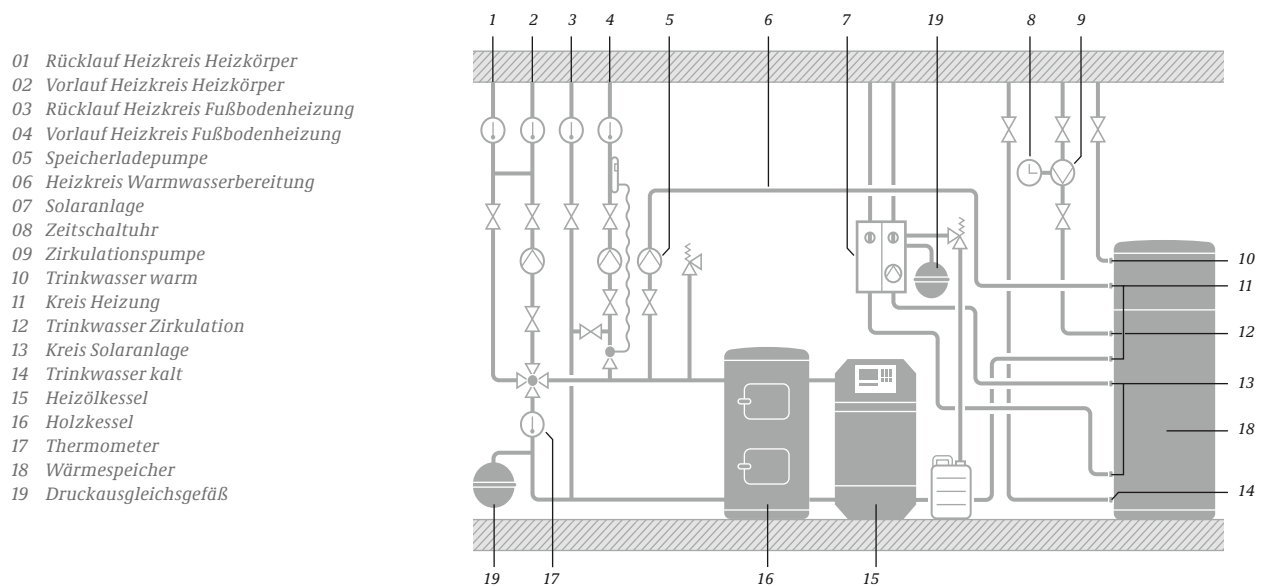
Beispiel einer komplexen Heizungsanlage mit Brennholzessel, Heizölkessel und eingebundener Solaranlage
